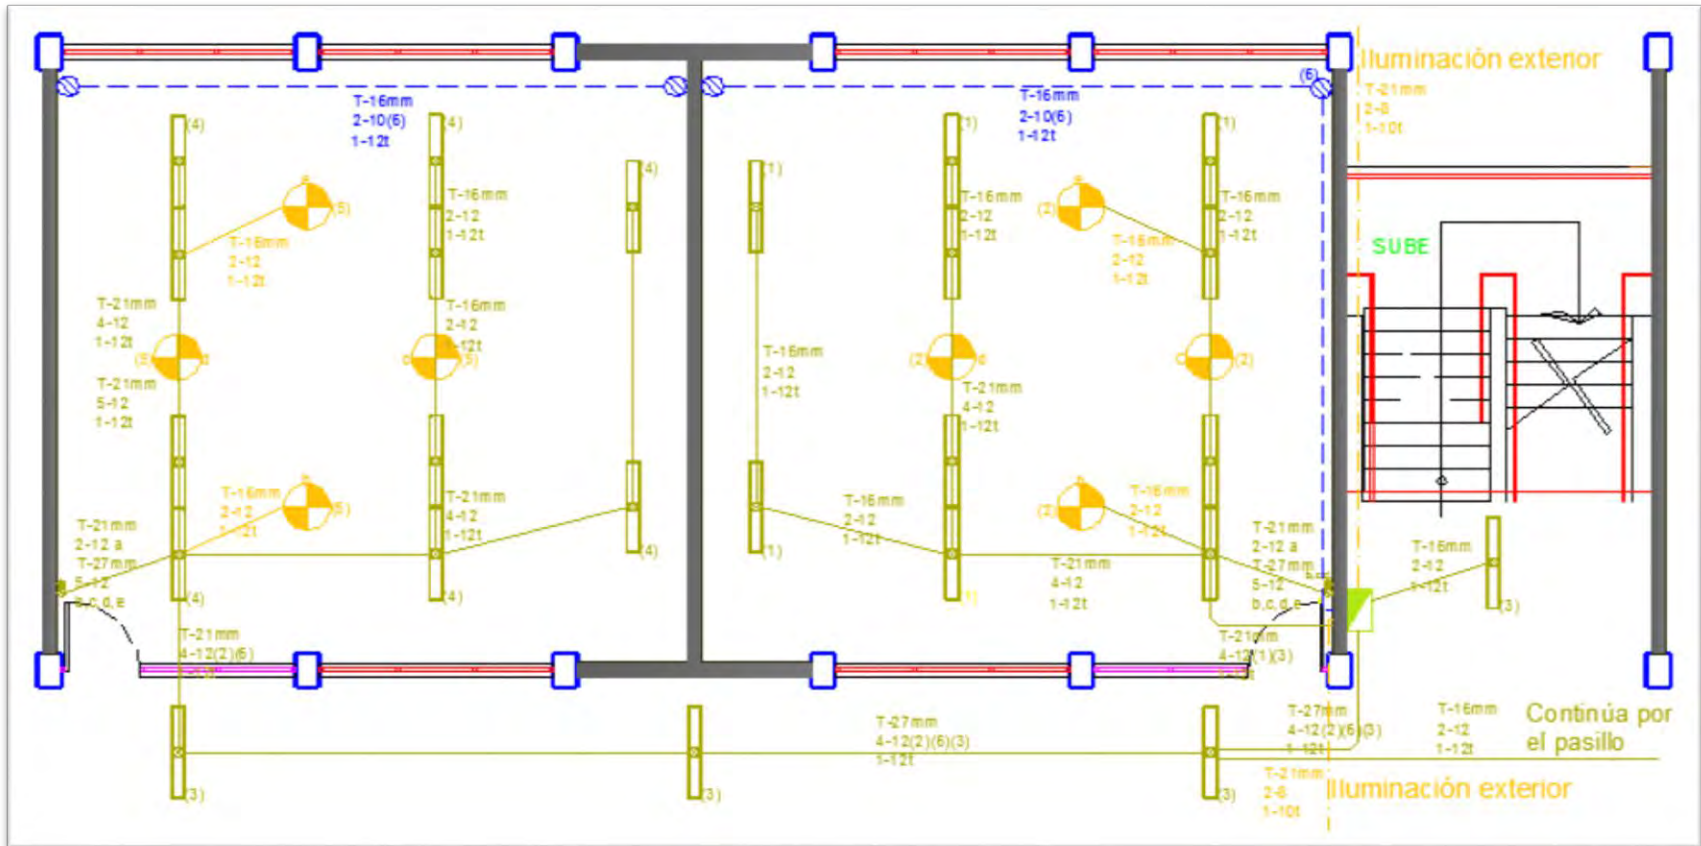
Plano de instalaciones de las aulas de la planta baja.
